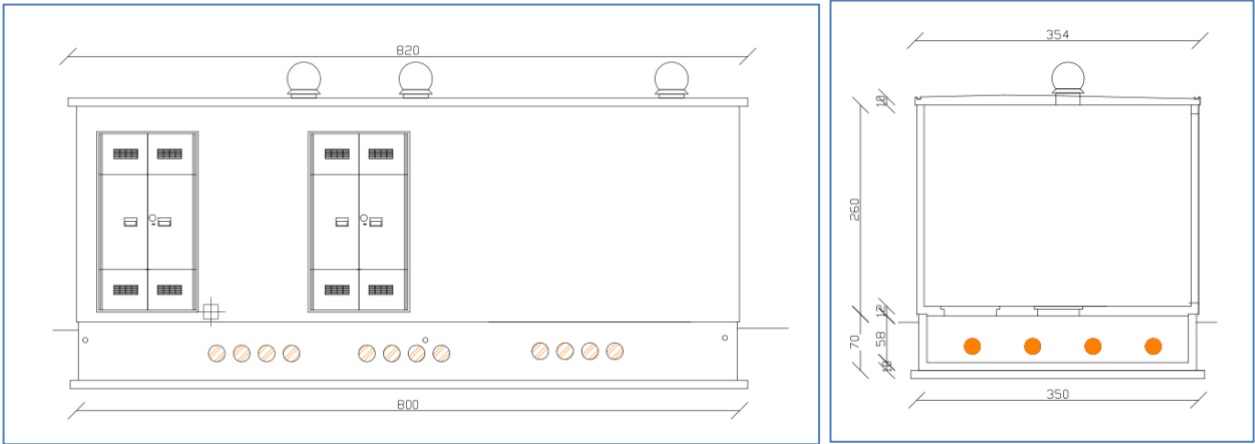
Prospetto lato campo e sezione tipo della cabina utente con posizionamento su vasca di fondazione
